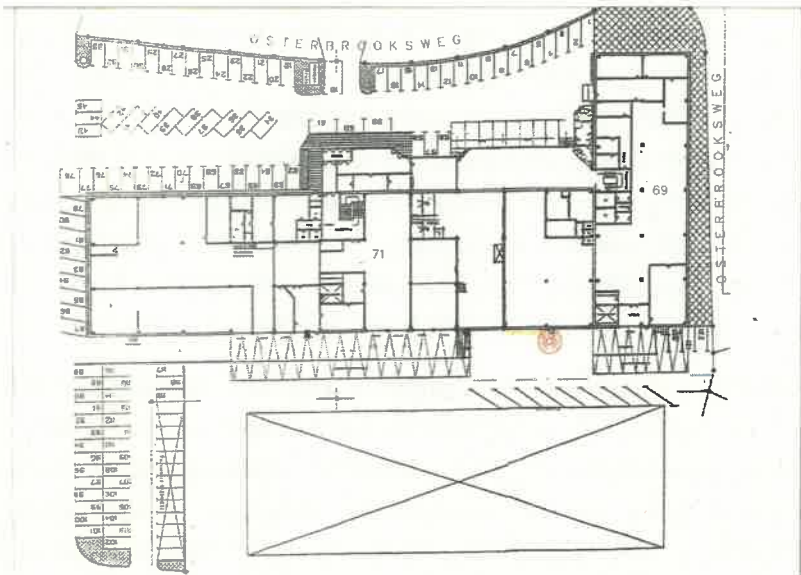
System-Grundriss mit vierachsigem (multifunktionalem) Stützenraster
